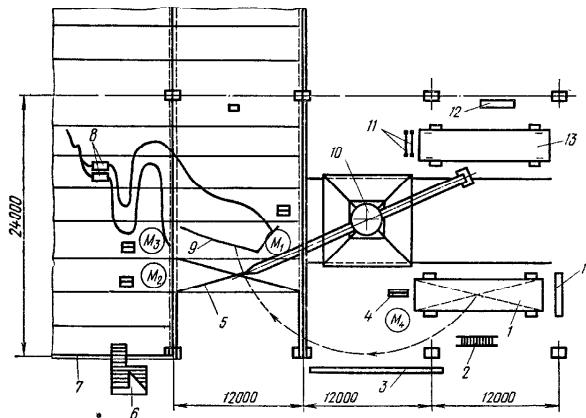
Организация рабочего места при монтаже плит покрытия промышленного здания:
